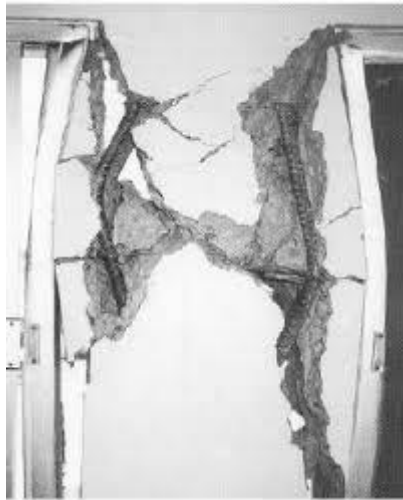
Grieta a compresión de una columna por exceso de carga.
